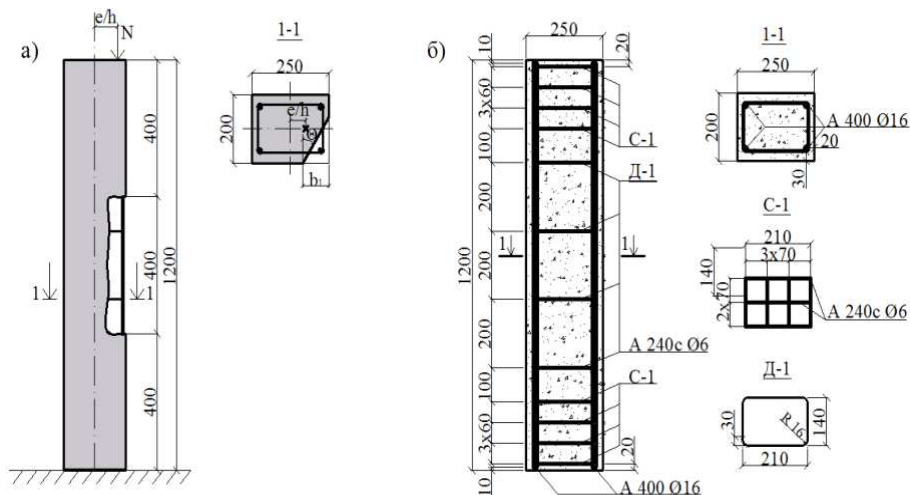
Опытный образец: а – общий вид поврежденного элемента; б – схема армирования
